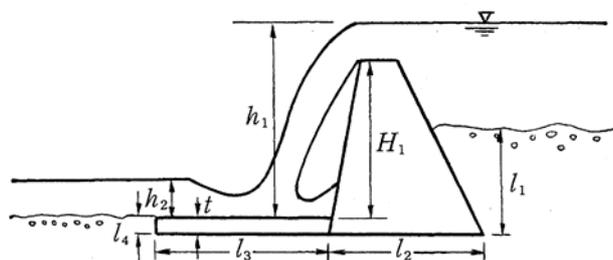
揚圧力から求める式による水叩きの厚さ
